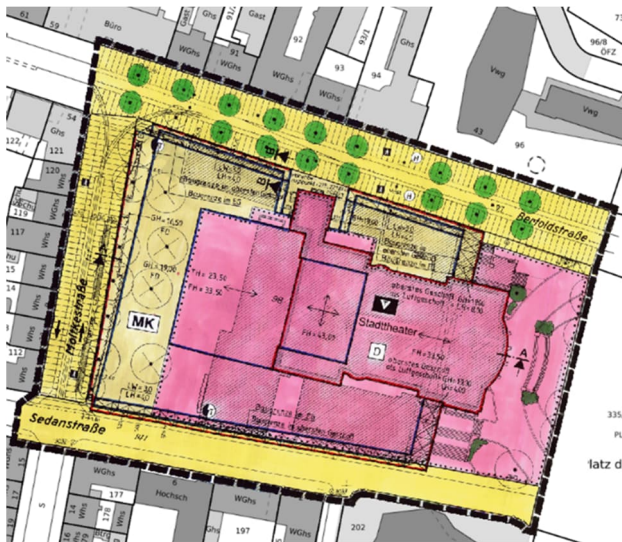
Bebauungsplan „Theater“, Plan-Nr. 1-58
